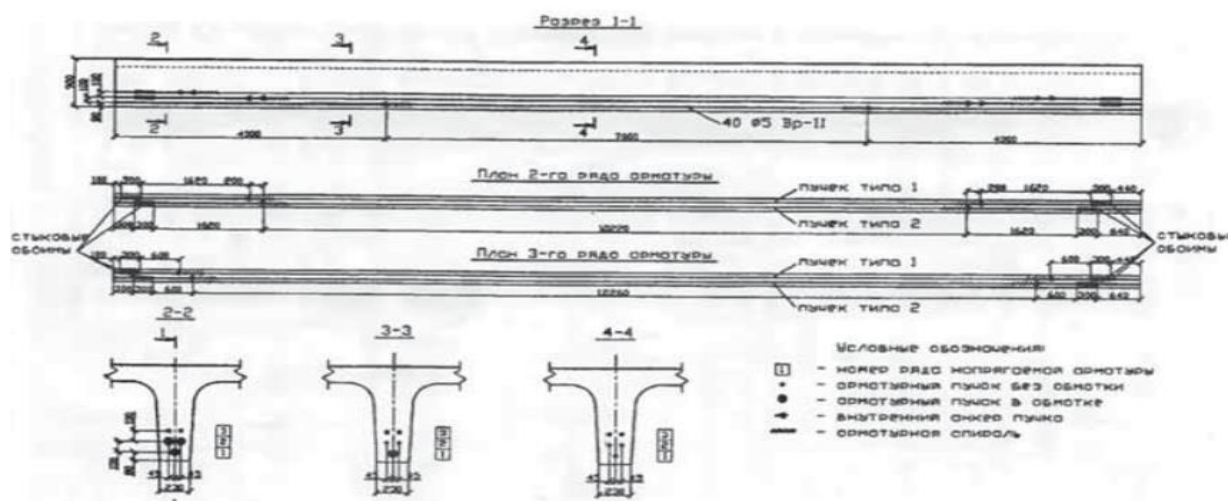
Схемы армирования железобетонных балок пролетного сооружения с применением напрягаемой стеклопластиковой арматуры
